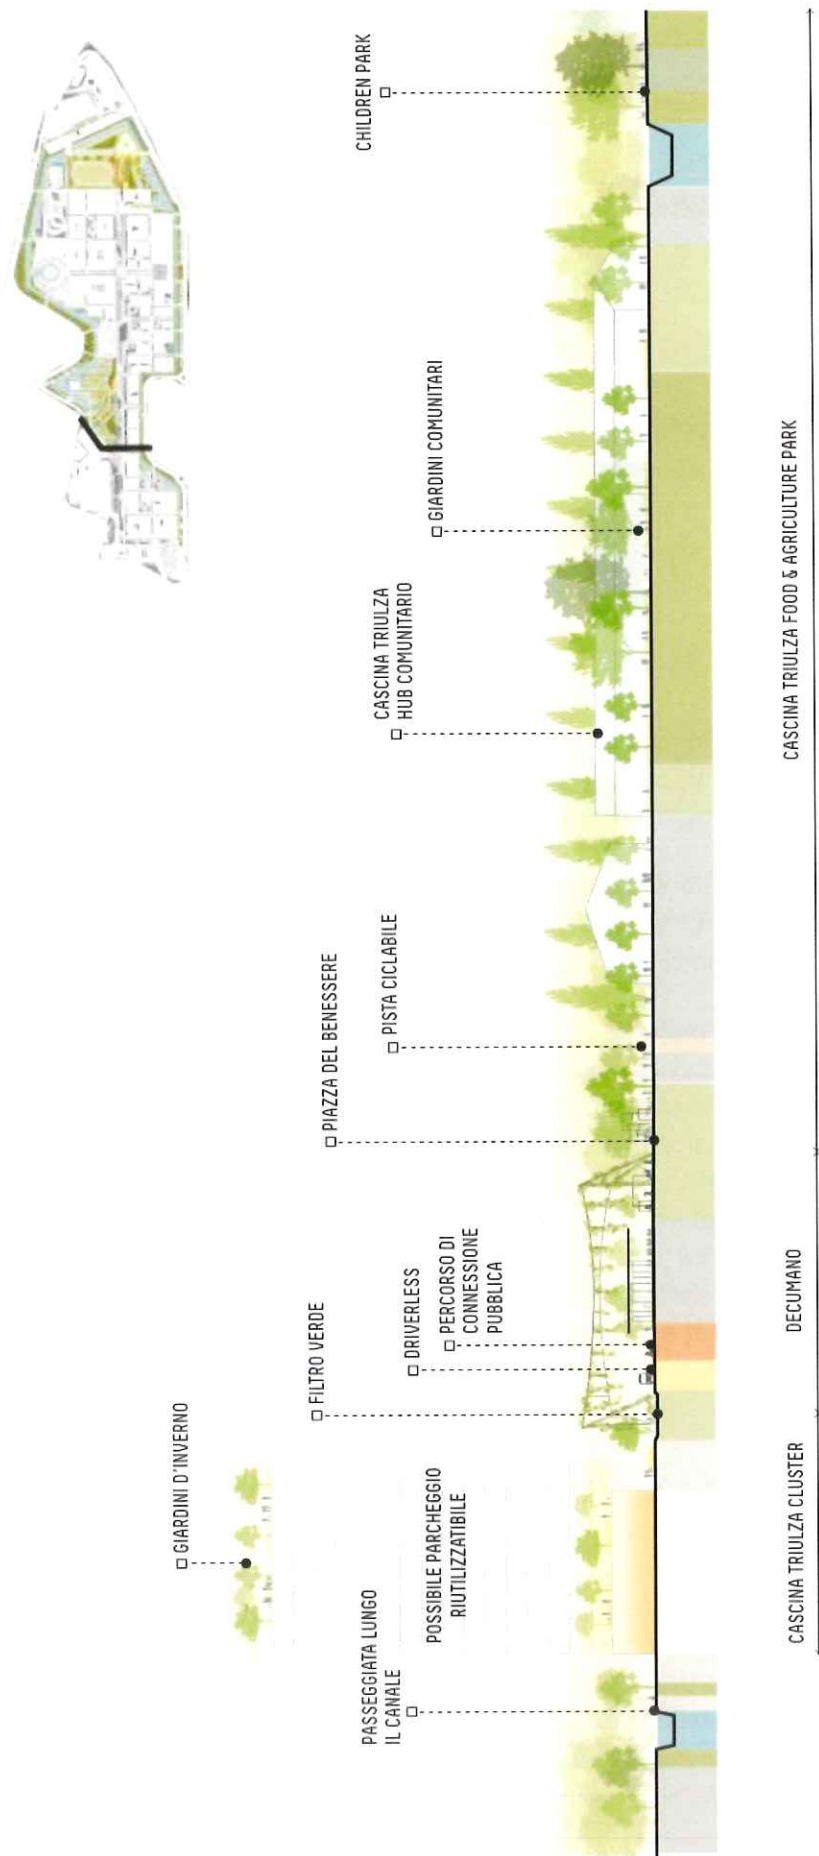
Piazza del Benessere – sezione paesaggistica tipo
